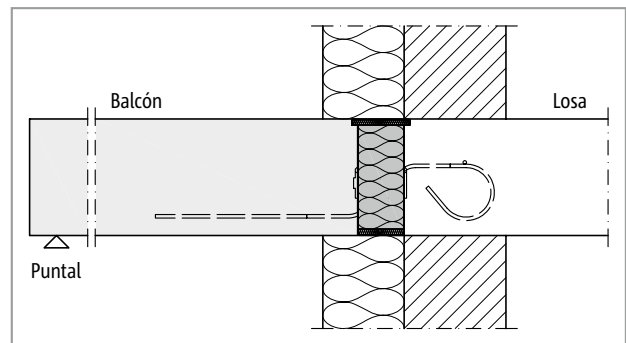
Schöck Isokorb® T tipo Z, Q: Sistema de aislamiento térmico exterior (SATE)
